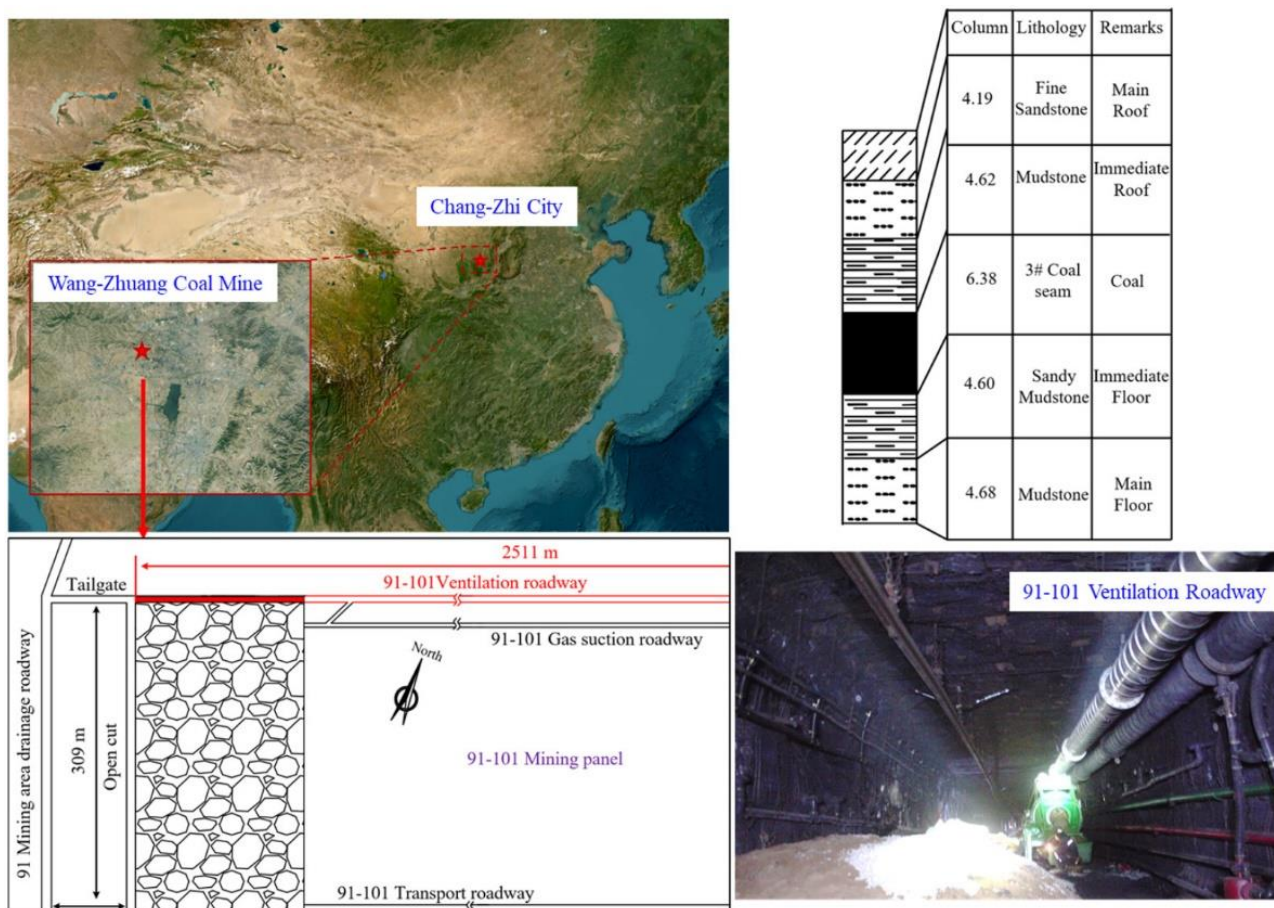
Местоположение, схема и сечение вентиляционного штрека 91-101 угольной шахты Ван-Чжуан
